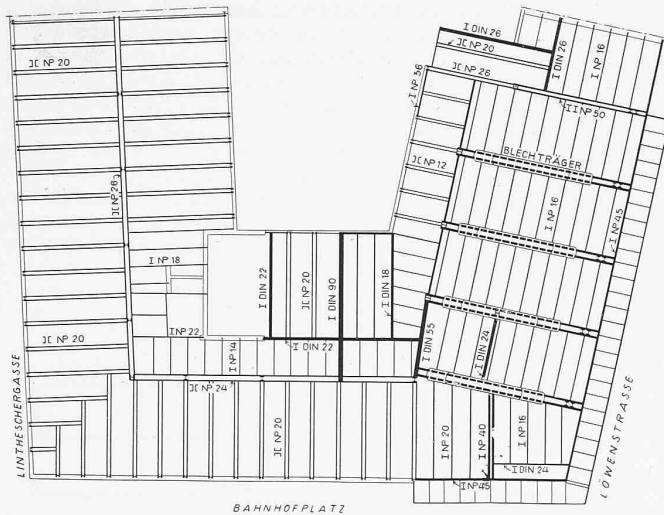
Balkenlage der Decke über Erdgeschoss. — Schema 1 : 400.
